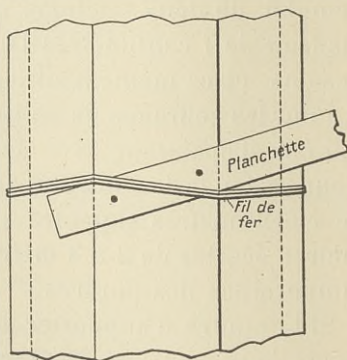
Élévation du coffrage d'un poteau de section octogonale.
